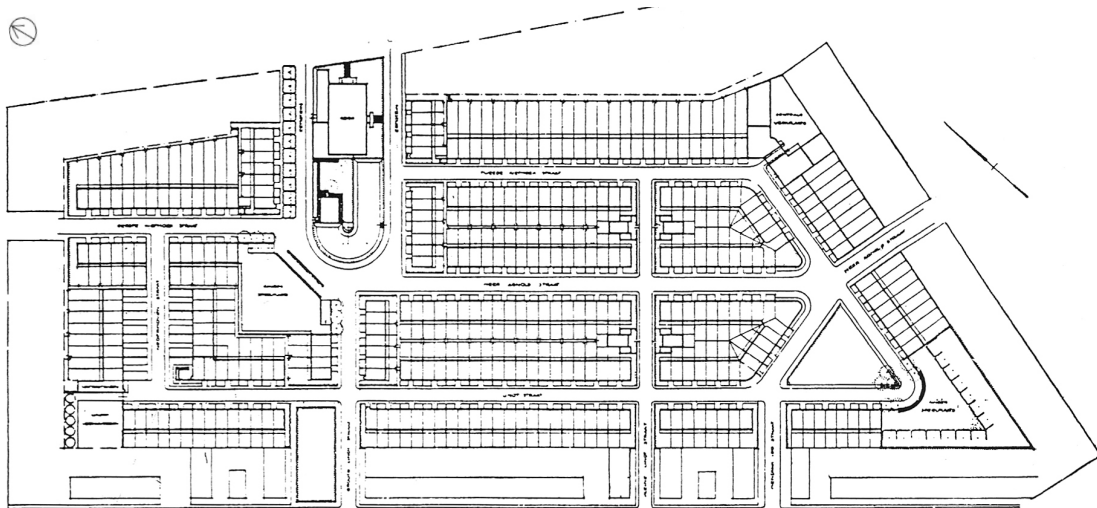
Planta geral do bairro de Kiefhoek, Roterdão, J.J.P. Oud.
